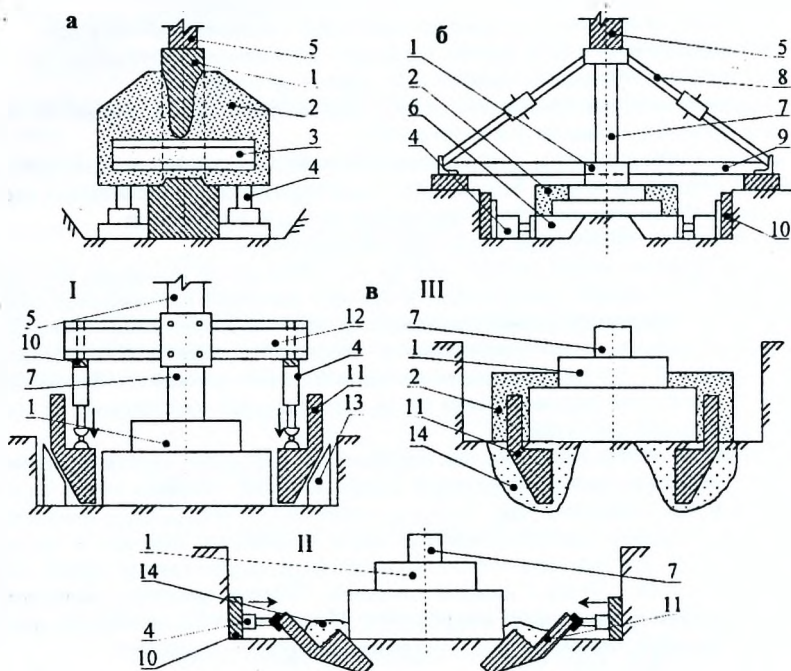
Усиление фундаментов обжатием гидродомкратами с помощью поперечных балок (а), задавливаемых под подошву плит (б) и блоков (в):
